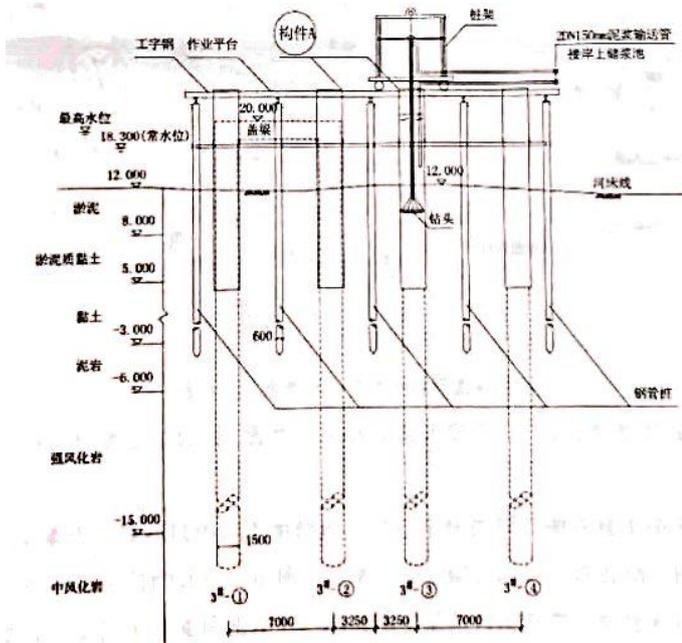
3#墩水上作业平台及桩基施工横断面布置示意图
